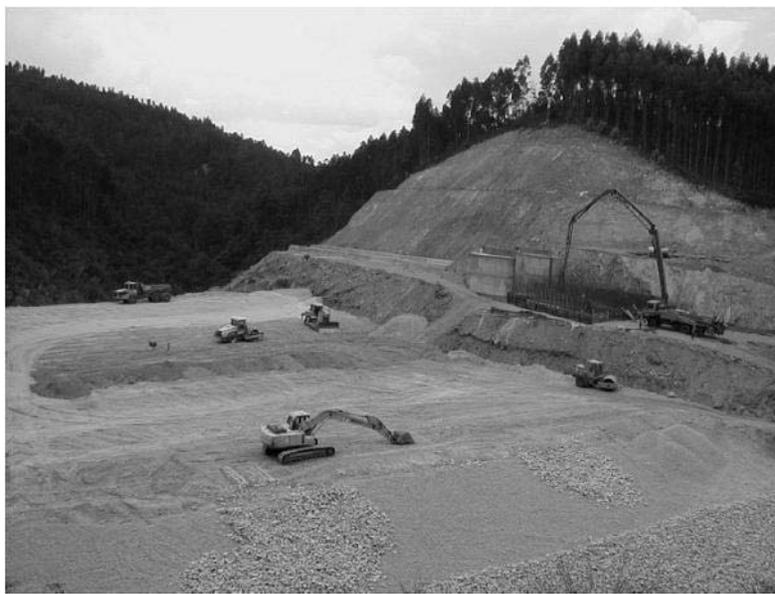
Aspecto da obra próximo do final de construção. Colocação da camada de transição e do enrocamento de montante
